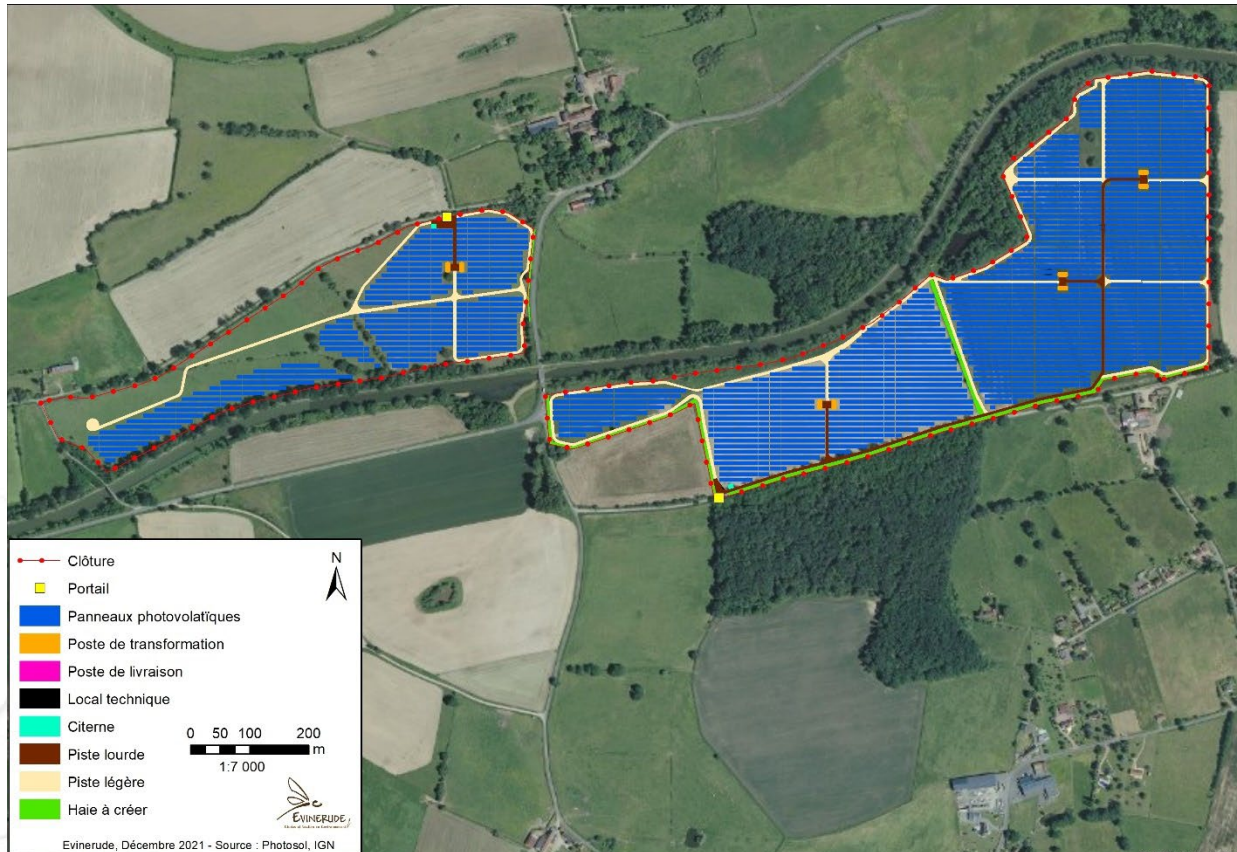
Plan d'implantation du projet- îlots Est et Ouest
